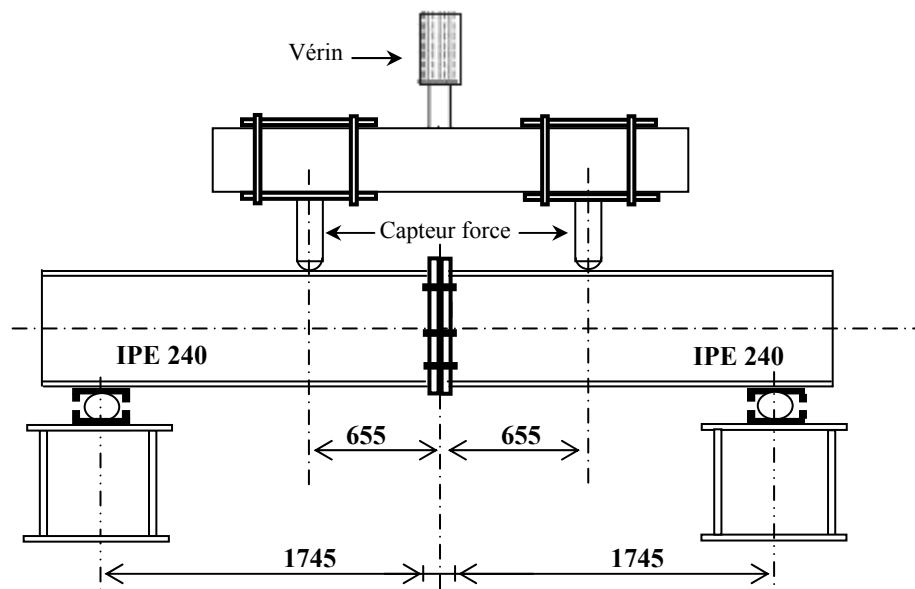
Montage d'essai (assemblage poutre-poutre)
